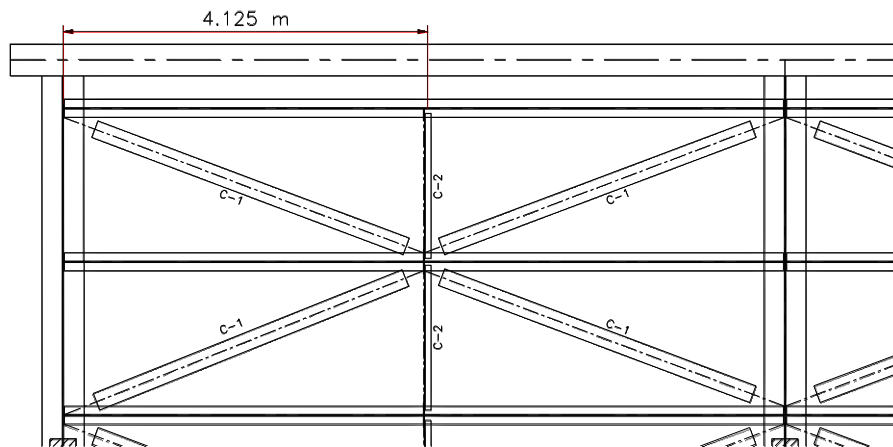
Vista parcial en planta del tramo carretero, se observan los contraventeos que restringen la longitud libre de pandeo de los largueros [4.3].
